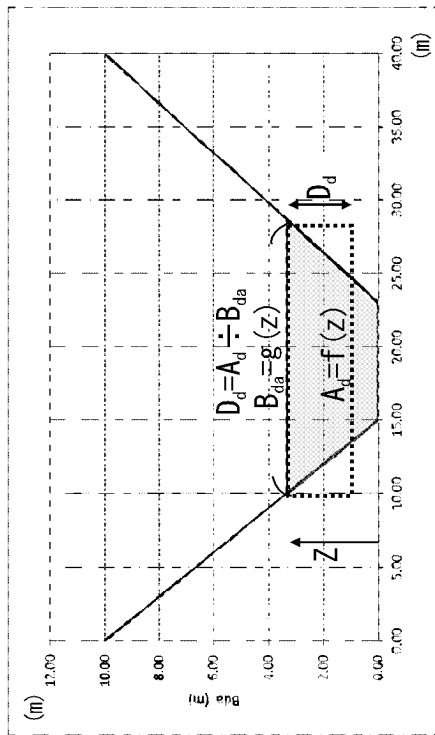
砂防堰堤計画地点上流の溪流横断面図
